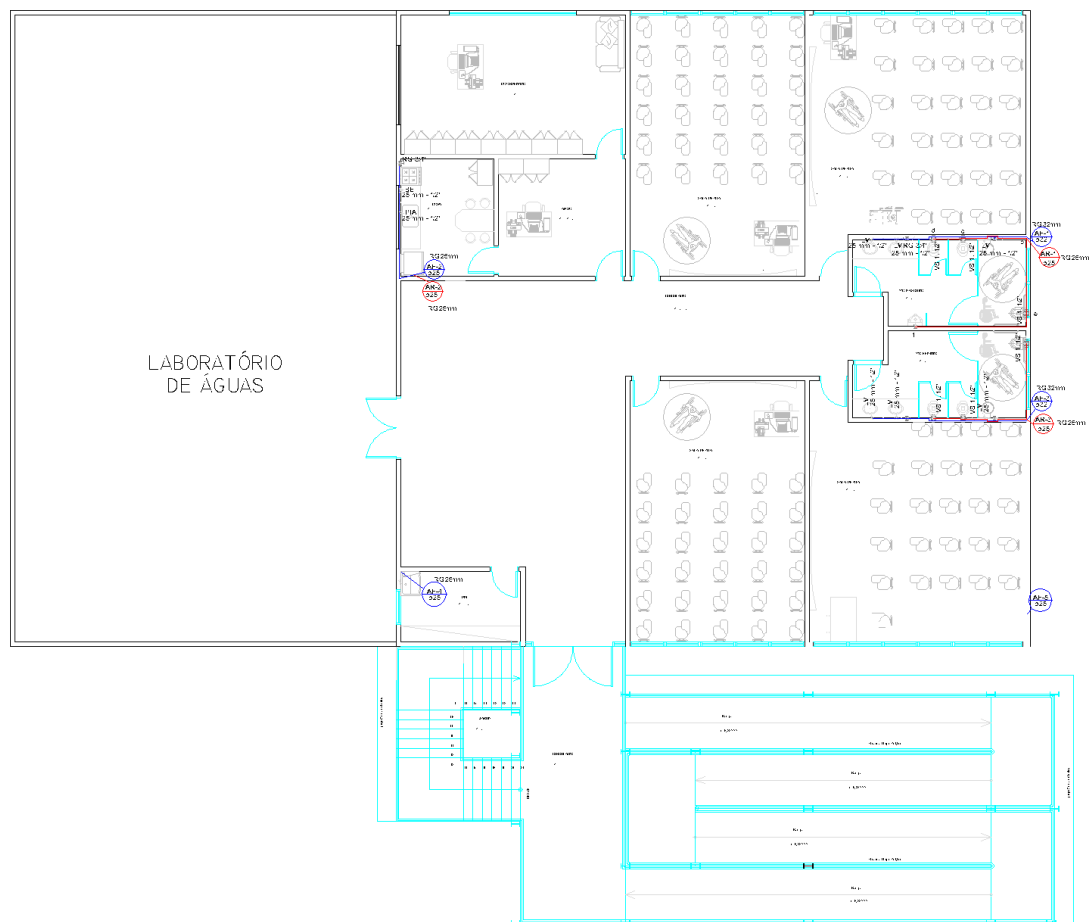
Projeto Hidráulico – Segundo Pavimento – CTEC. Fonte: Autores (2022).
